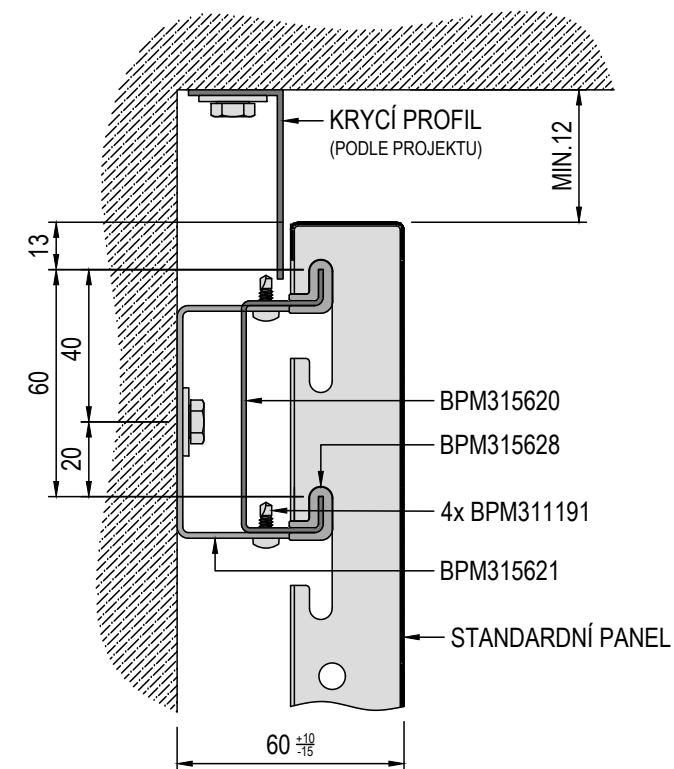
PŘECHOD NA KOVOVÝ PODHLED
